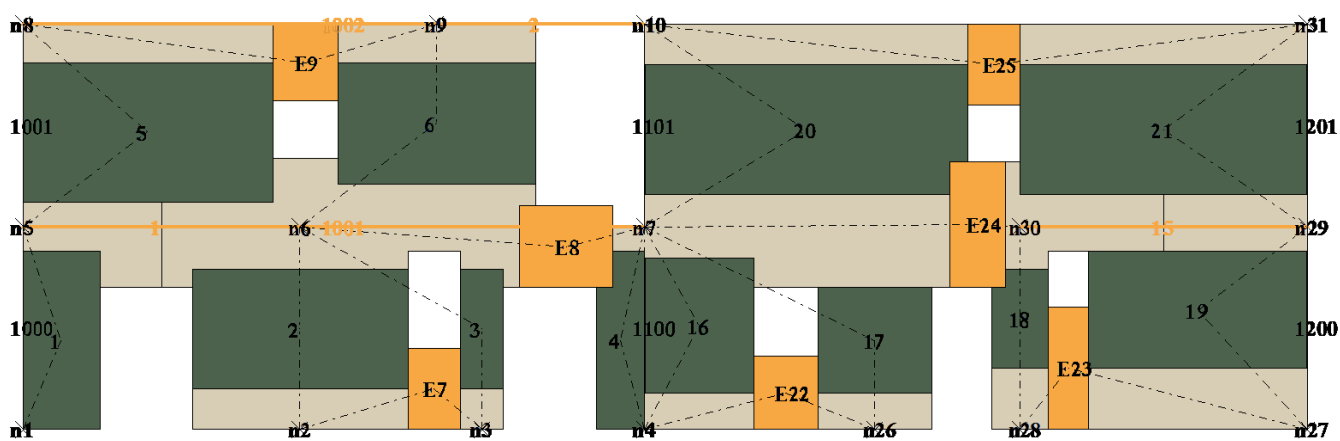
Prospetto Parete 1 - Modello Collegato singola parete
